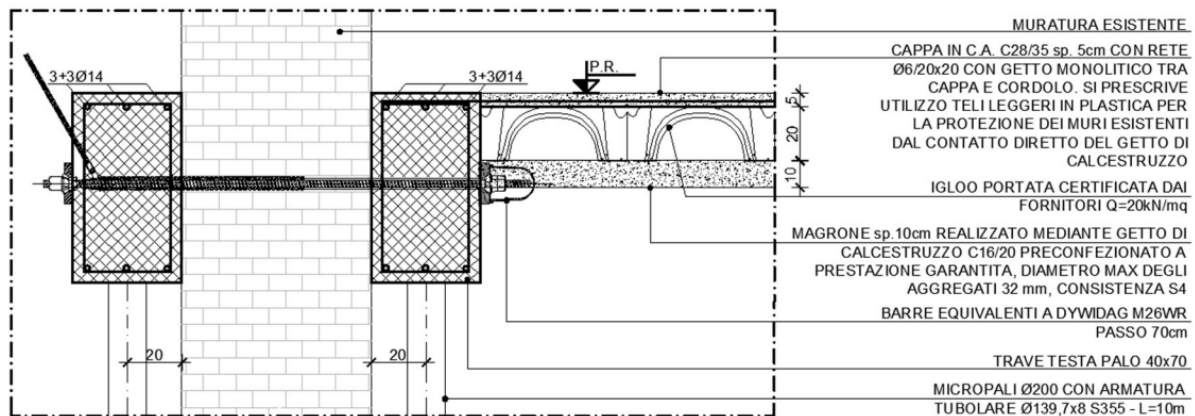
sottofondazioni con micropali in acciaio infissi nel terreno e connessione delle travi testa-palo con barre tipo DYWIDAG (disegni tecnici da progetti per il recupero della Ex Caserma Sacchi di Pavia, lavori di Studio Calvi BEAM BEAM).
